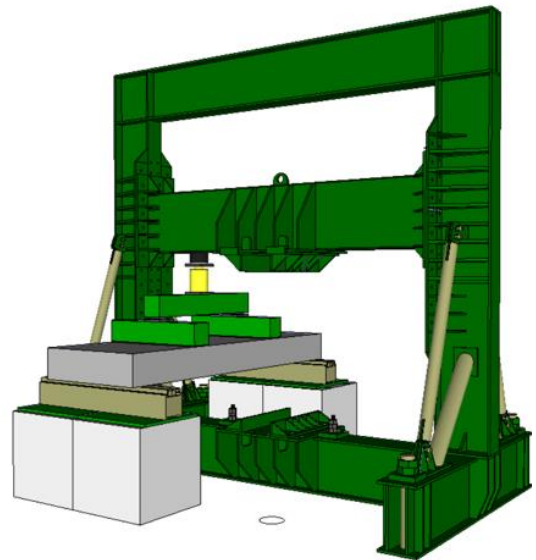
Detalhe do sistema de ensaio com vista em corte
